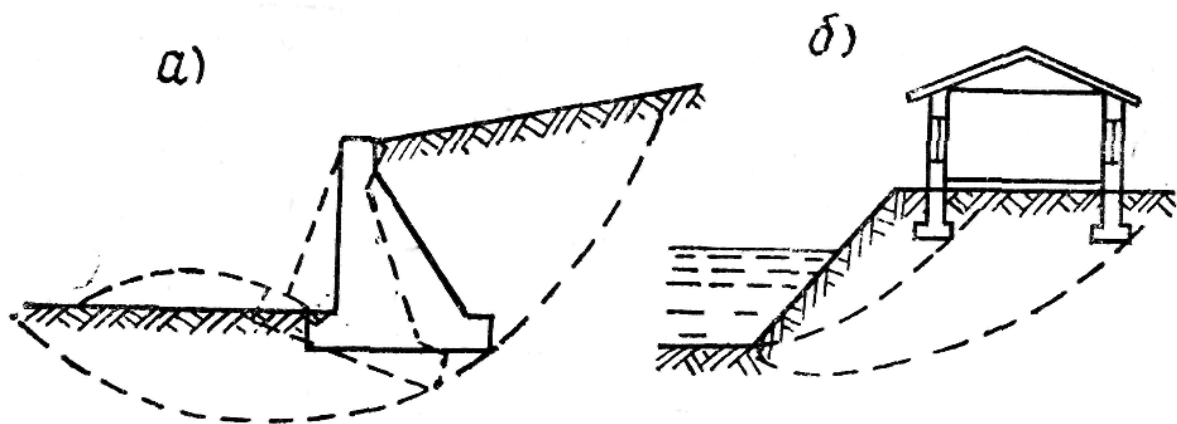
Схеми основ споруд, які розраховуються на стійкість:
